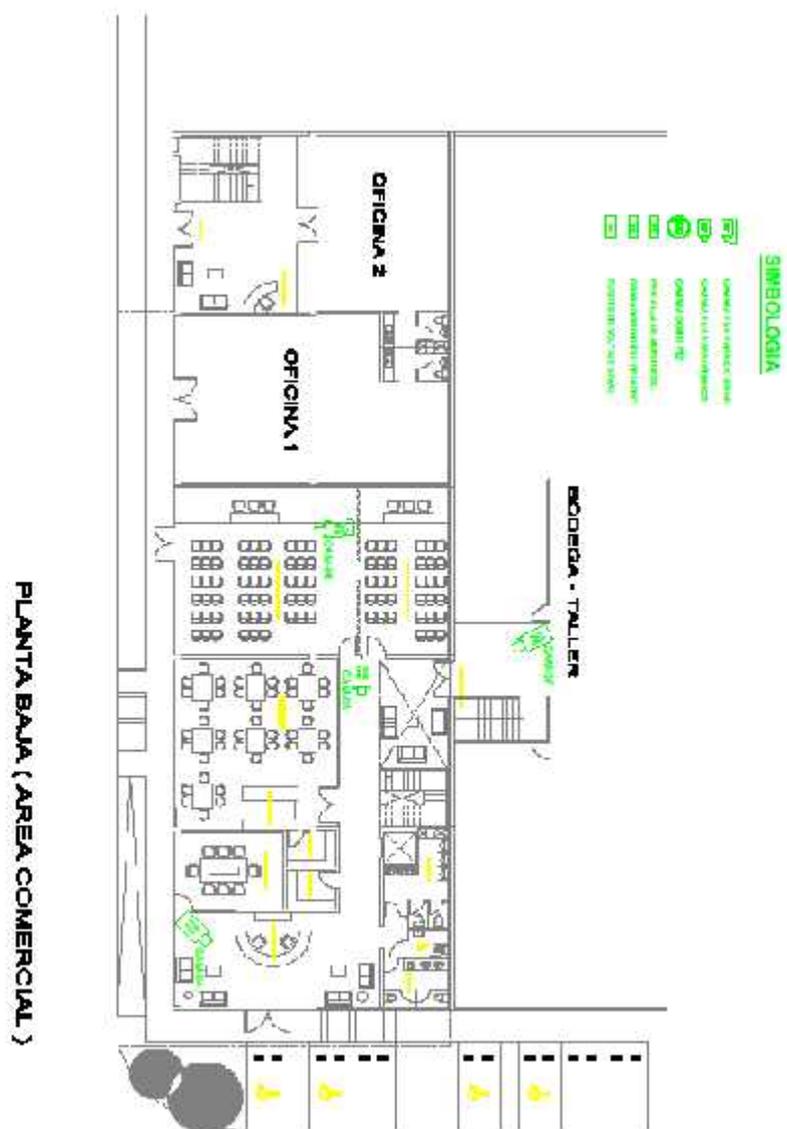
Cámaras CCTV en la planta baja del área comercial
